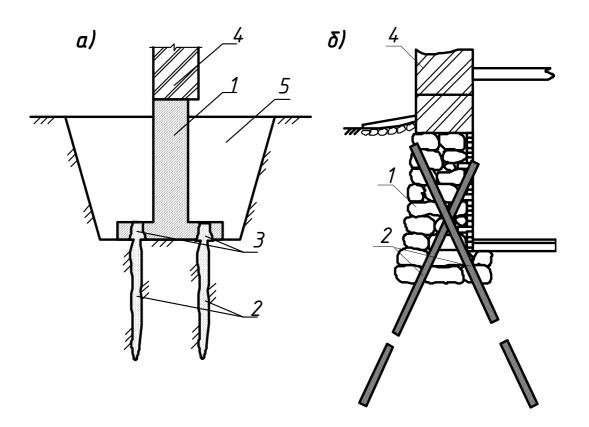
Передача нагрузки от стены на буроинъекционные сваи: а - вертикальные сваи; б - наклонные сваи; 1 - усиливаемый ленточный фундамент; 2 - буроинъекционные (корневидные) сваи, устраиваемые через плитную часть усиливаемого фундамента; 3 - конусные отверстия в плитной части фундамента, устраиваемые после инъекции цементно-песчаного раствора; 4 - кирпичная стена; 5 - пазух, заполняемый грунтом после устройства стыка свай с плитной частью фундамента.
